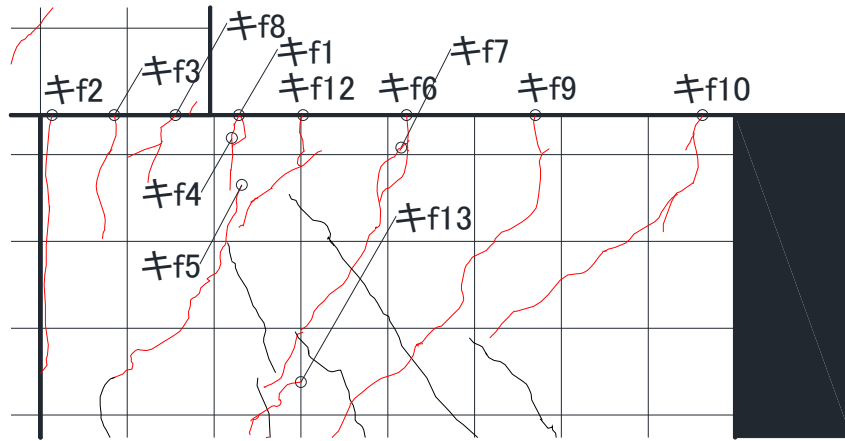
基礎梁ひび割れ幅測定位置(試験体 DR-1 -7.0 サイクル 観測面)
